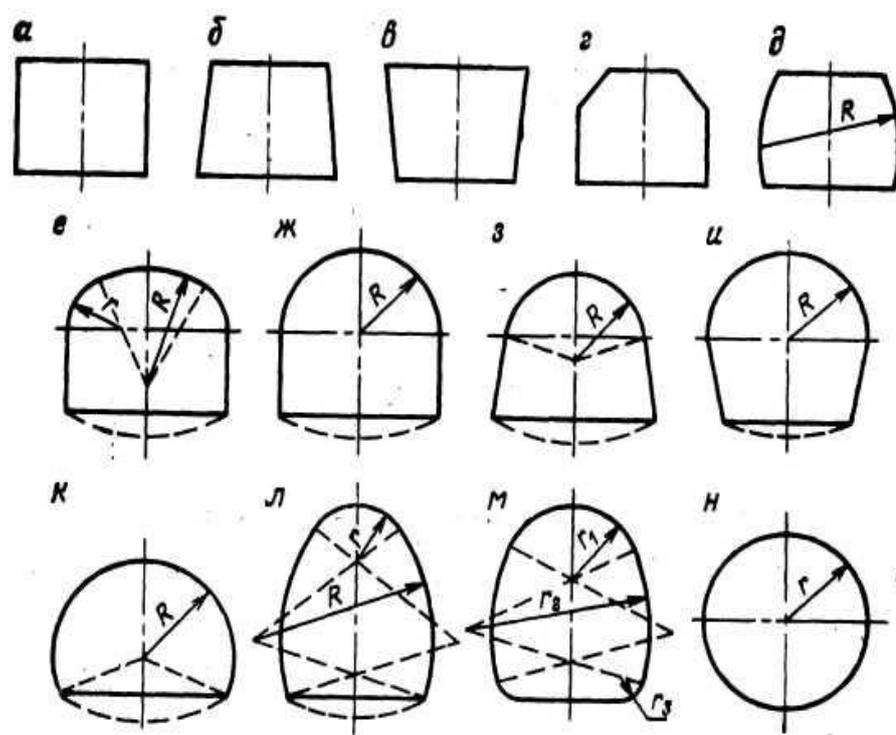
Формы поперечного сечения выработок: а – прямоугольная; б и в – трапецевидные; г – полигональная; д – бочкообразная; е, ж, з, и – сводчатые с вертикальными и наклонными стенами (формы сводов; е – трехцентровый пониженный; ж, и – полуцирульный; з – цирульный пониженный); к, л, м – подковообразные, соответственно, цирульного, трехцентрового и пятицентрового очертания; н – круговая
